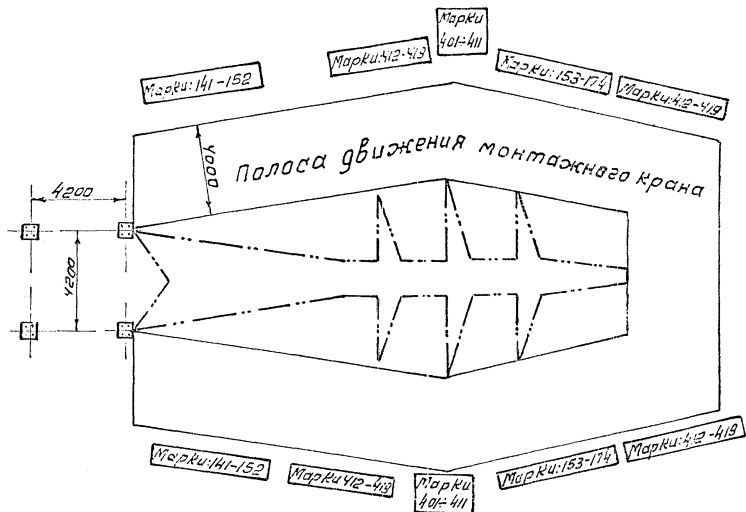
Раскладка пакетов с деталями опоры на пакете
